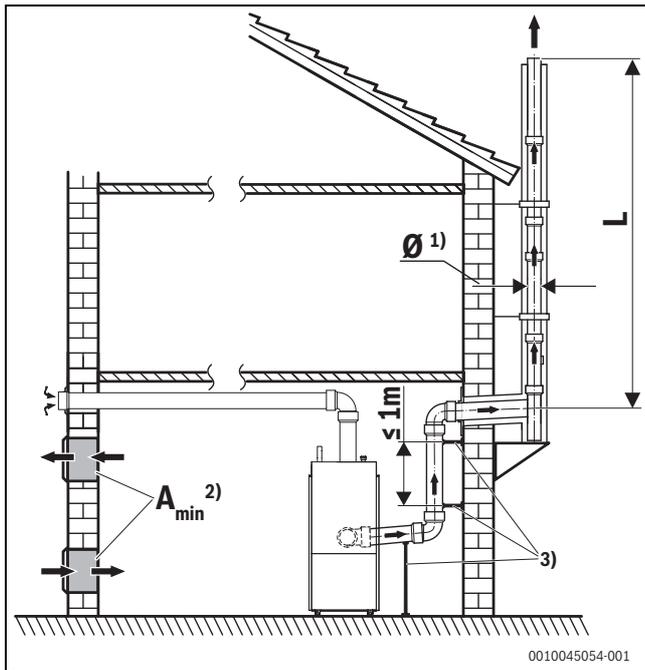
Hauteur effective de la conduite d'évacuation des fumées, sans conduit, systèmes sur façade, variante 4
